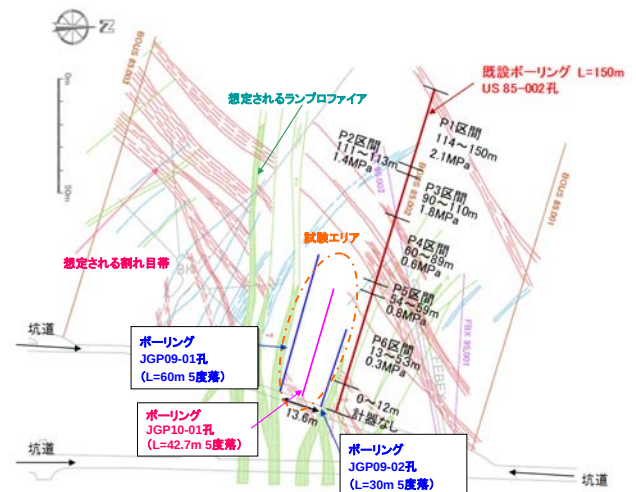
試験エリア周辺の地質構造と試錐孔の配置（水平面図）
